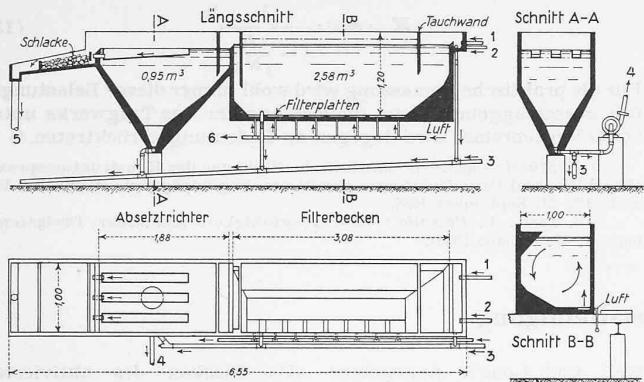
Z-Versuchsanlage in St. Gallen. Grundriss und Schnitte 1:100.
